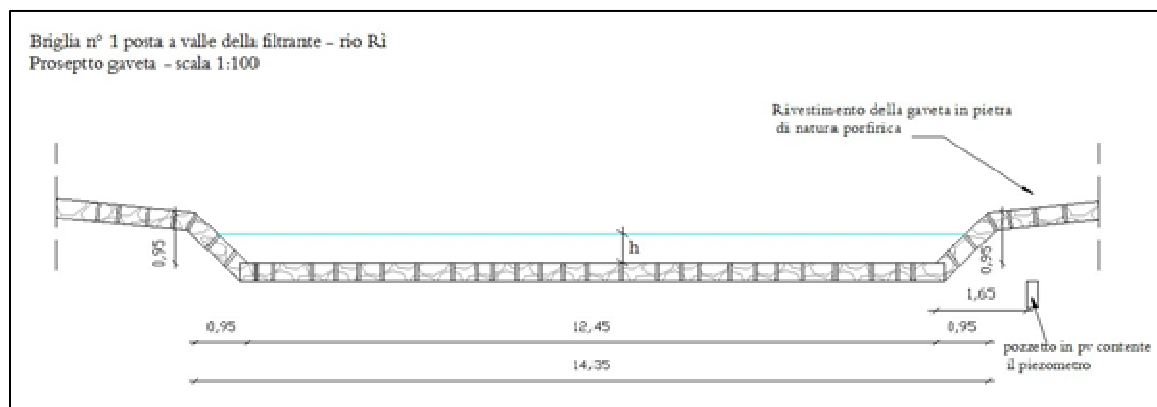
Prospetto gaveta briglia n°1 posta a valle della filtrante sul rio Rì.
